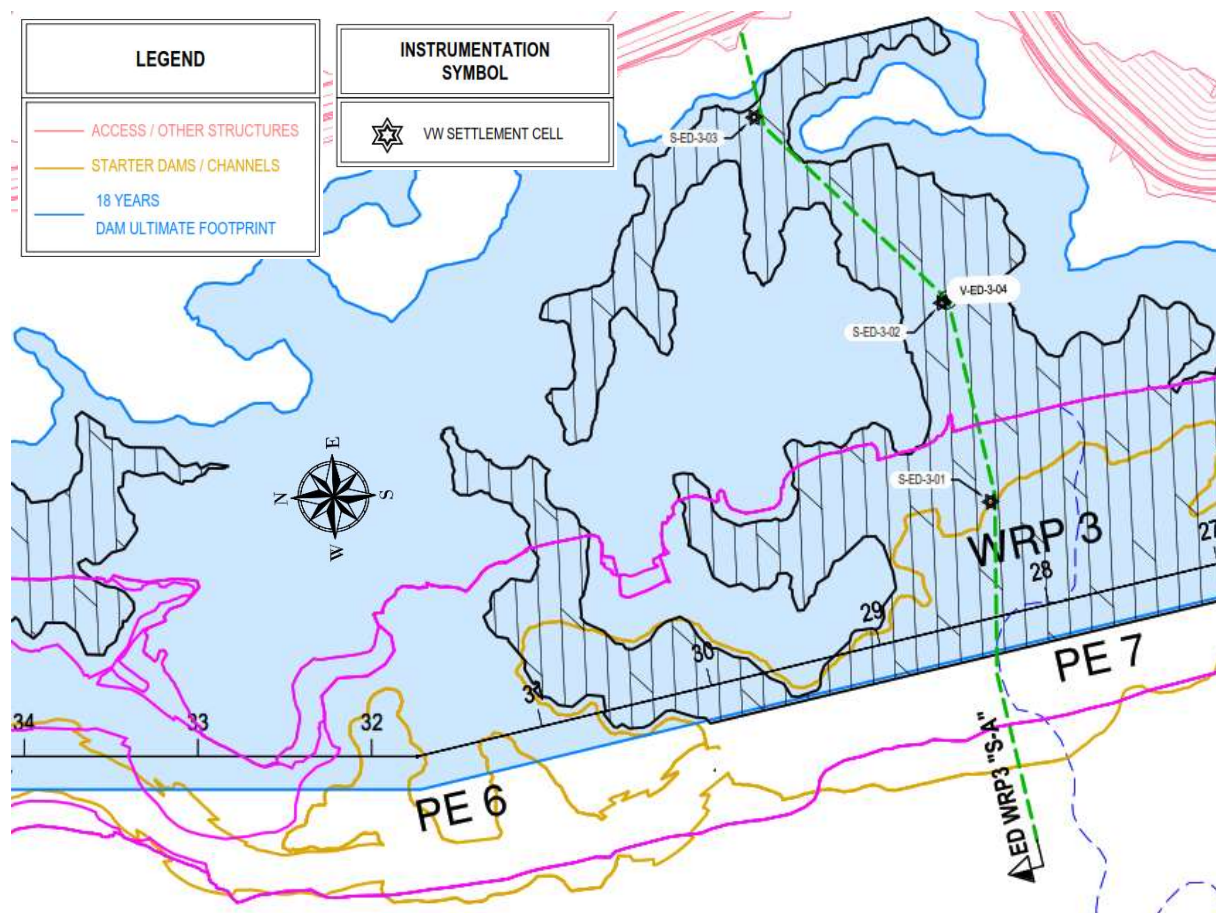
1: Vista en planta de la PE WRP3 – Grupos de instrumentos de la celda de asentamiento
